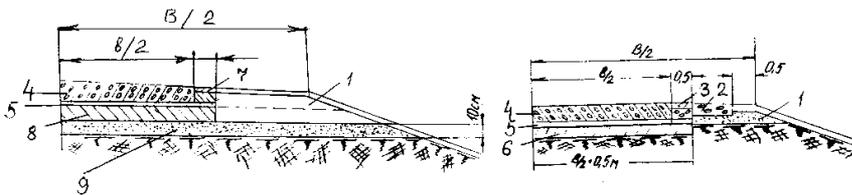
Поперечные профили дорожных одежд с цементобетонным покрытием:
